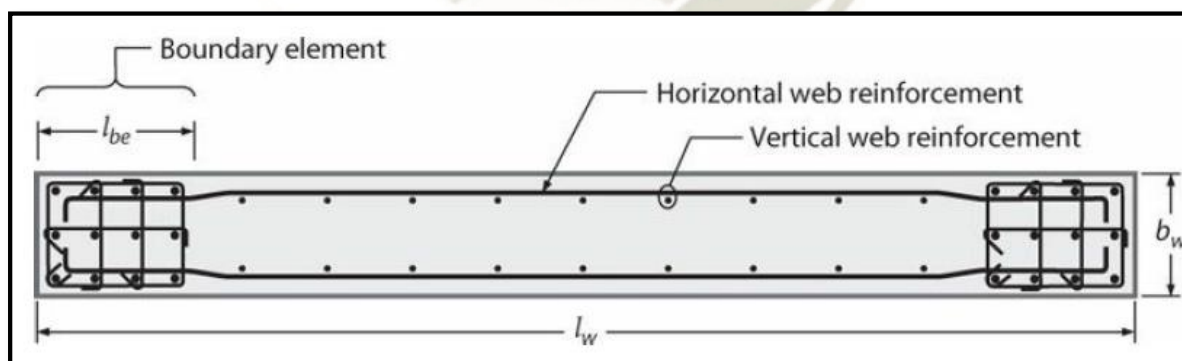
Armado de acero del muro confinado (Moehle, 2014)
